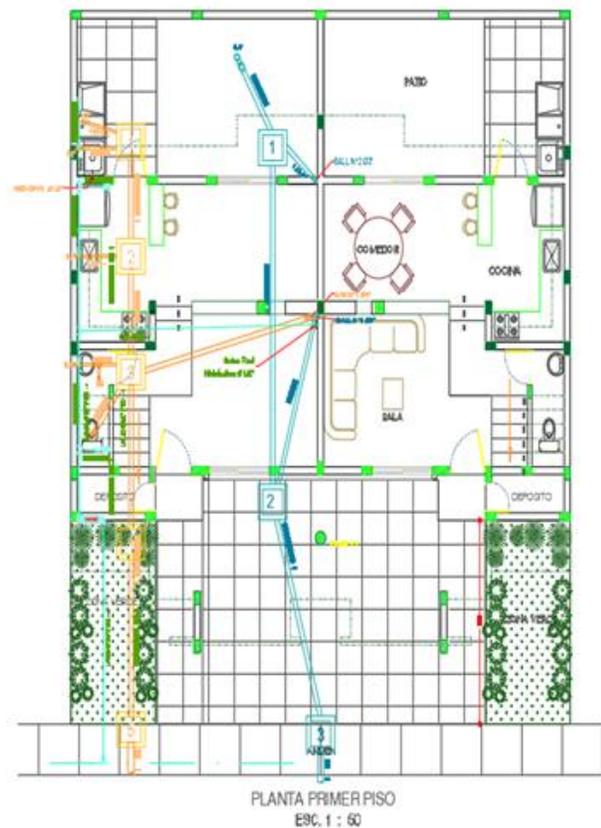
Plano de red de tuberías y cajas alcantarillado sanitario y pluvial.
